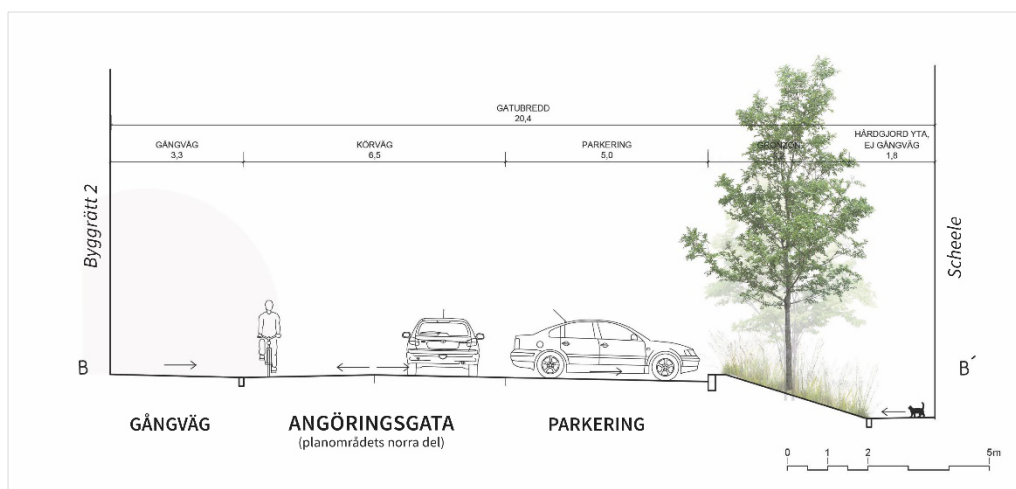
Sektion som visar angöringsgatan i planområdets norra del. Sektionen är dragen mellan den östra byggnaden som detaljplanen möjliggör och den byggnad som kallas Scheele. Illustration: CF Møller Architects
